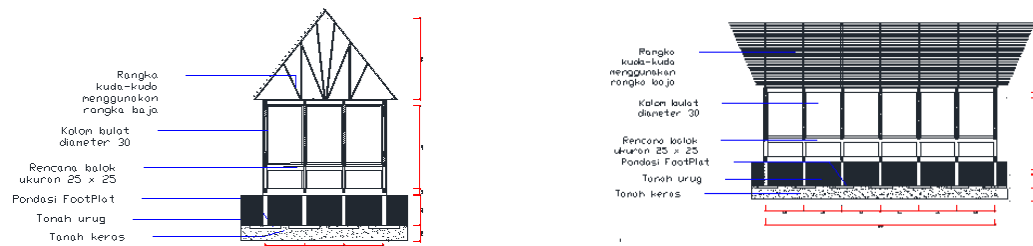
Denah Bangunan Pelayanan dan Rekreasi
